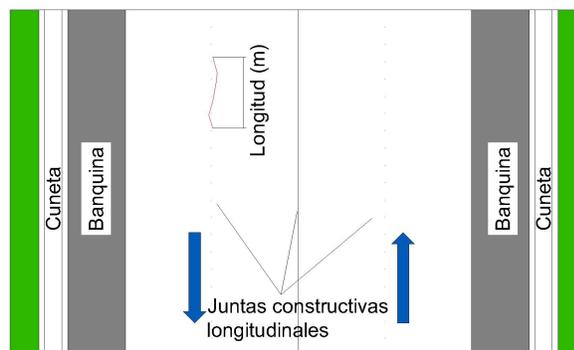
Fisura longitudinal en juntas de construcción (FCL, Unidad de medida: m², penalidades: m²-carril)
